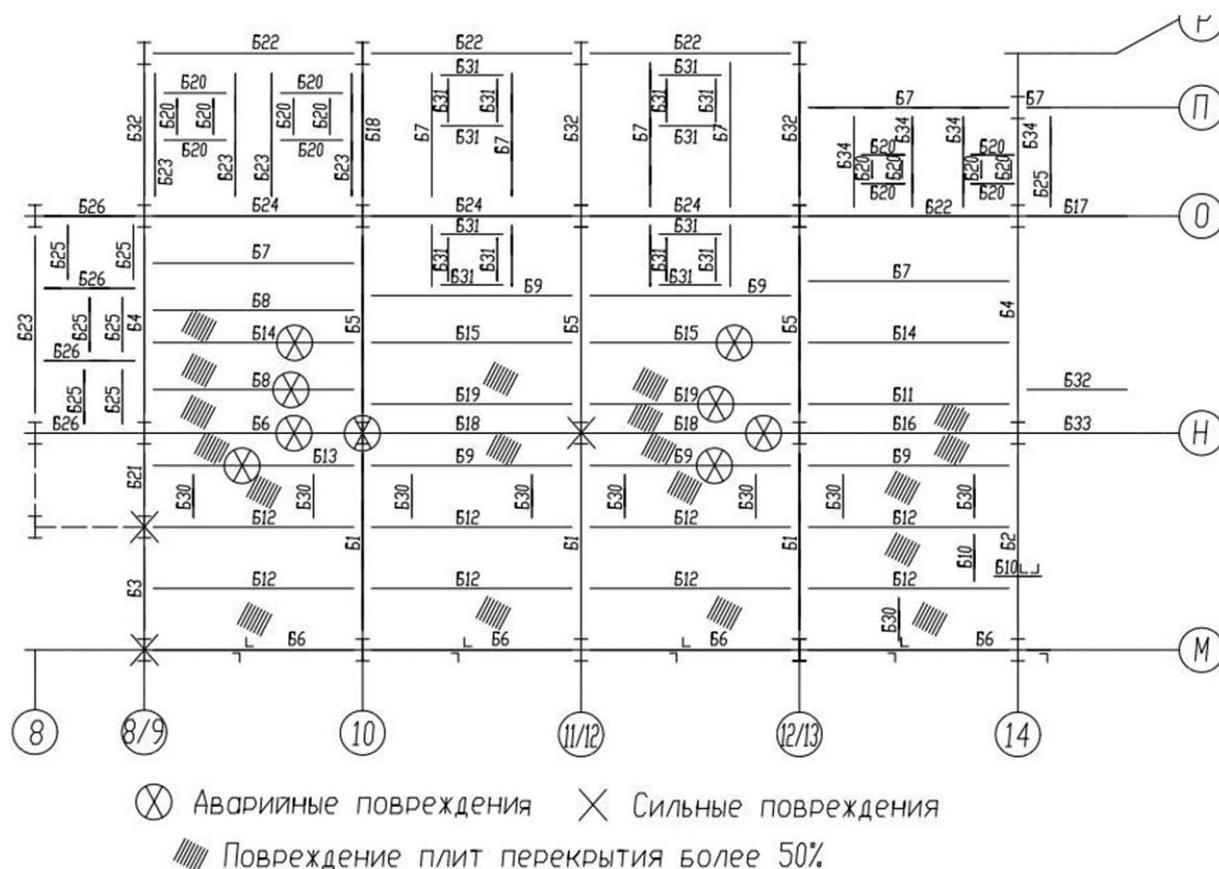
Карты повреждений стоек, балок и плит перекрытия на отметке 4,800
